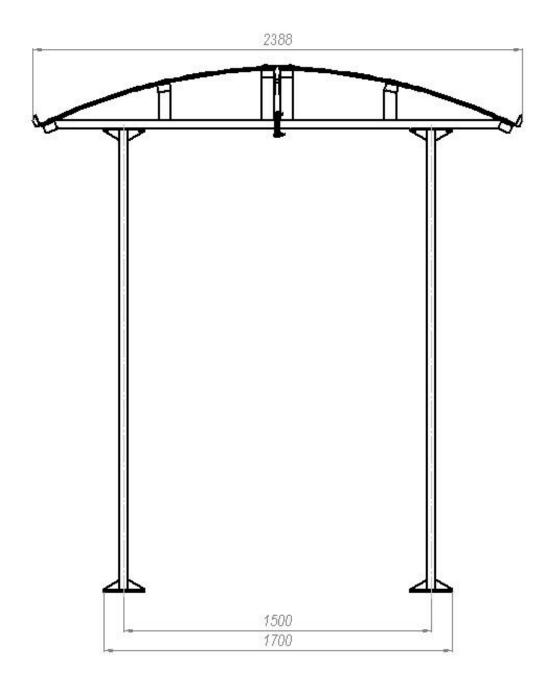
(а) – Габаритные размеры крыши (вид с торца)
